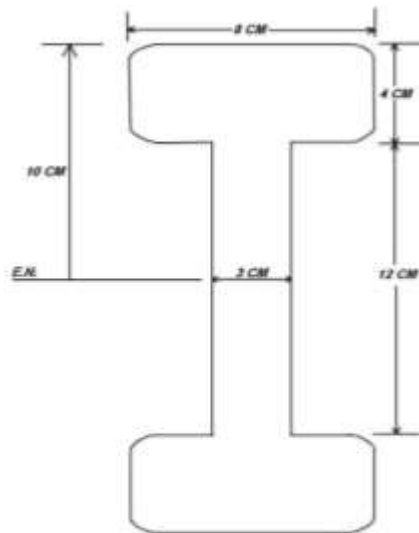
Geometría de la sección transversal de una viga H20. Reyes, (2021)
